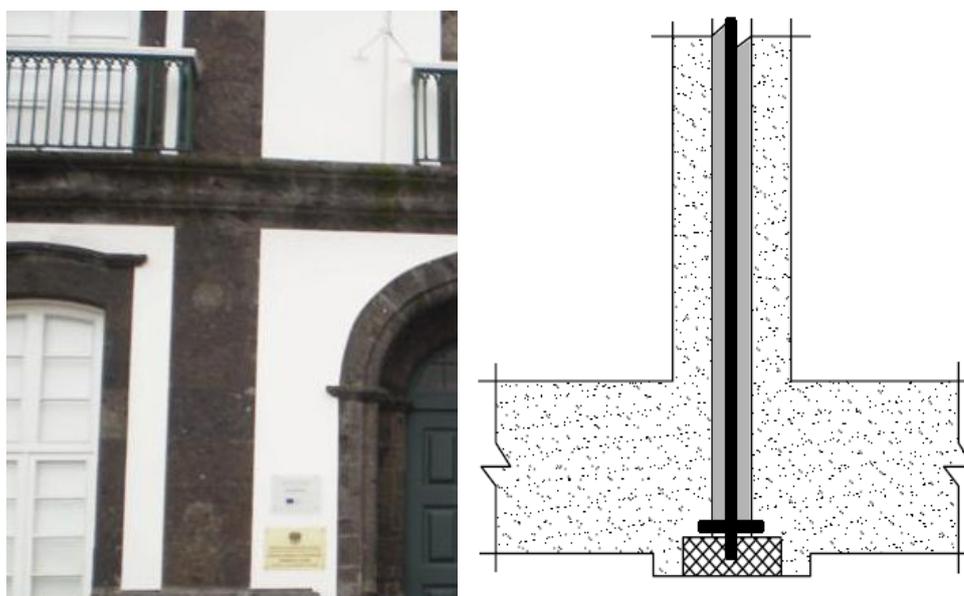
Esquema das pregagens nas paredes ortogonais e aspecto exterior da fachada nas zonas de furação
